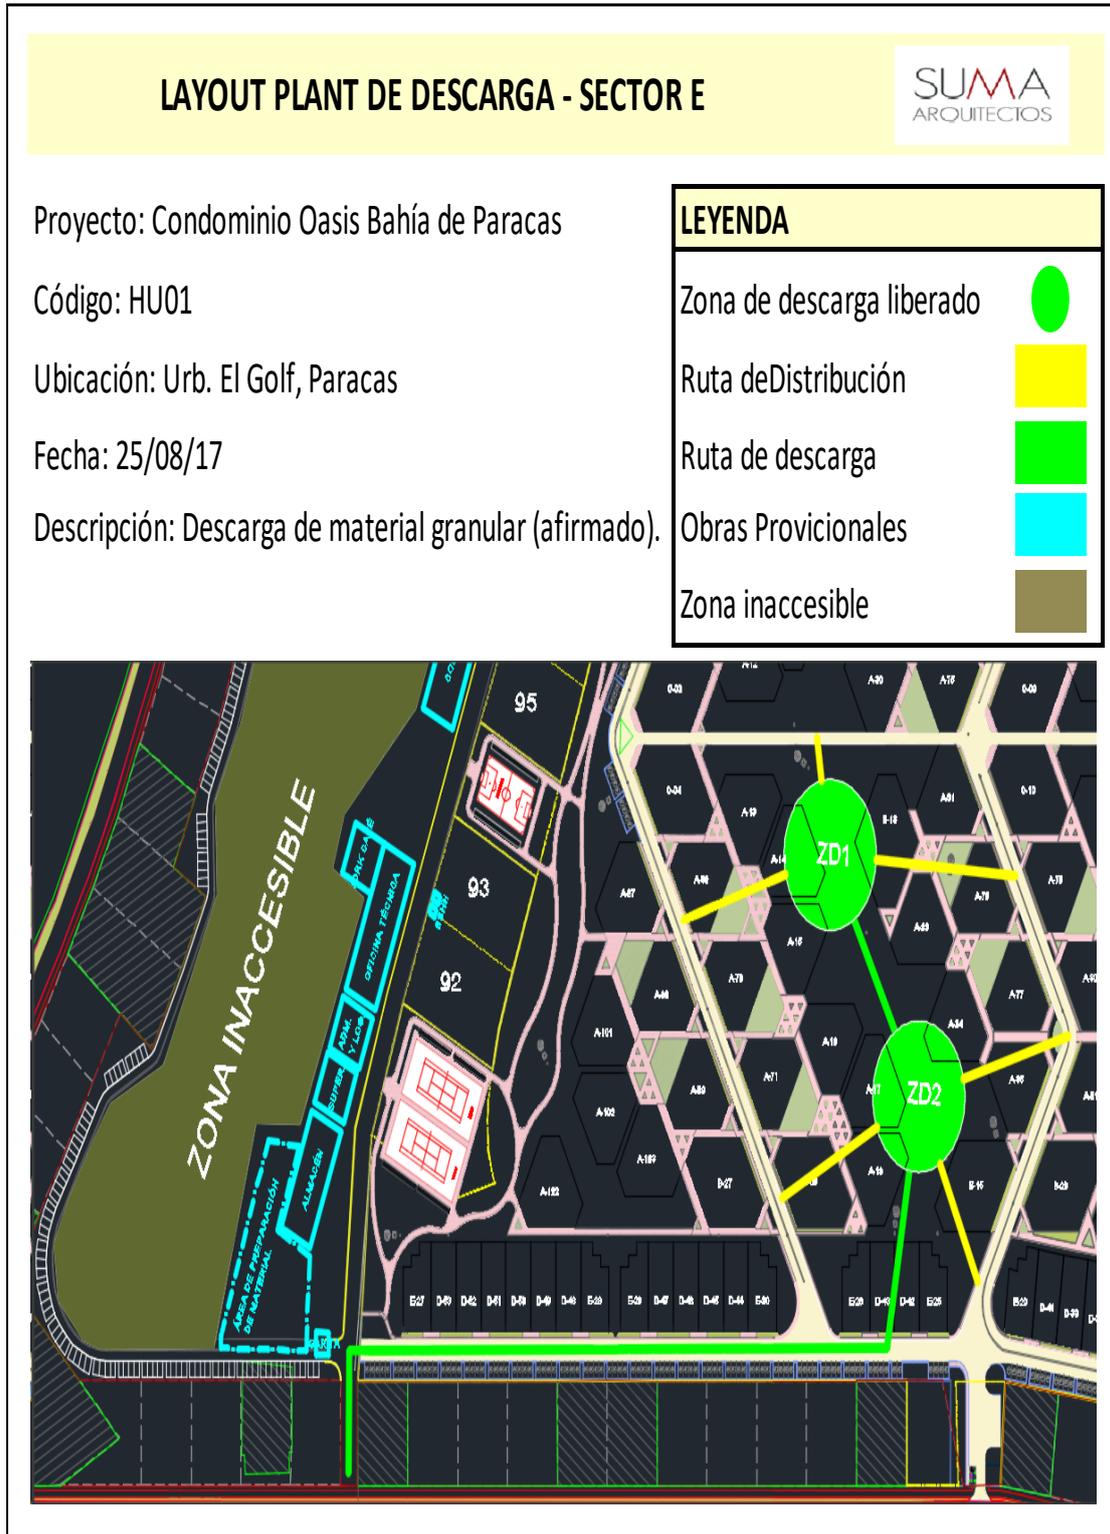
Layout plant - descarga de afirmado en función a la liberación de restricciones. ¹³¹
